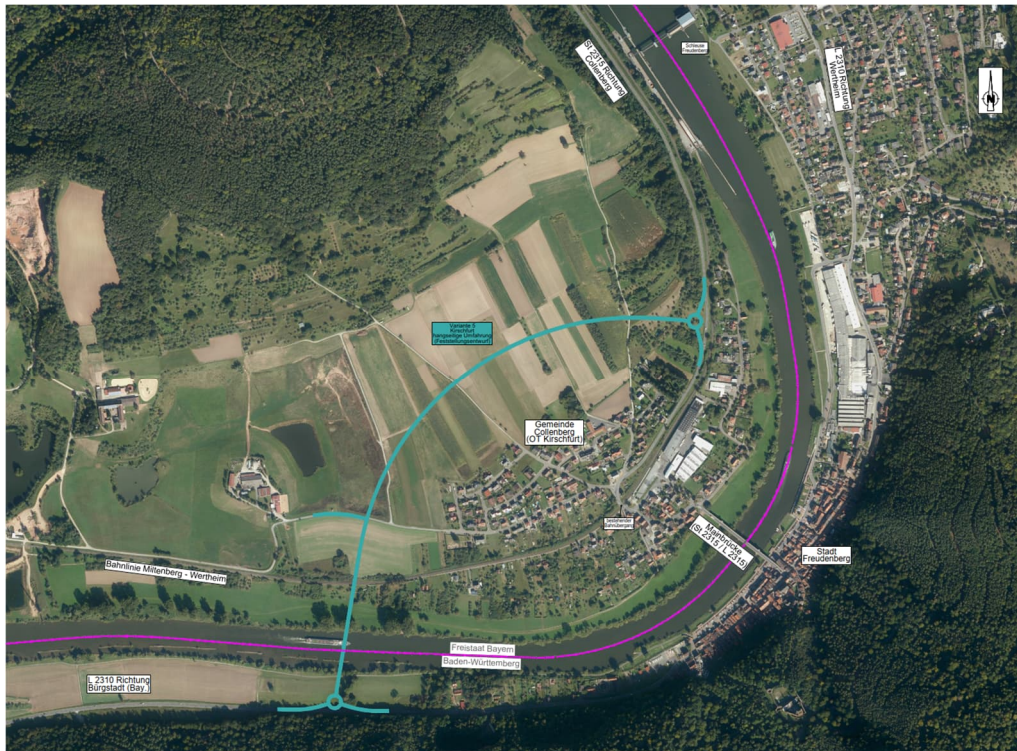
Variante 5 - St 2315 OU Kirschfurt, hangseitige Umfahrung (Vorzugsvariante)
